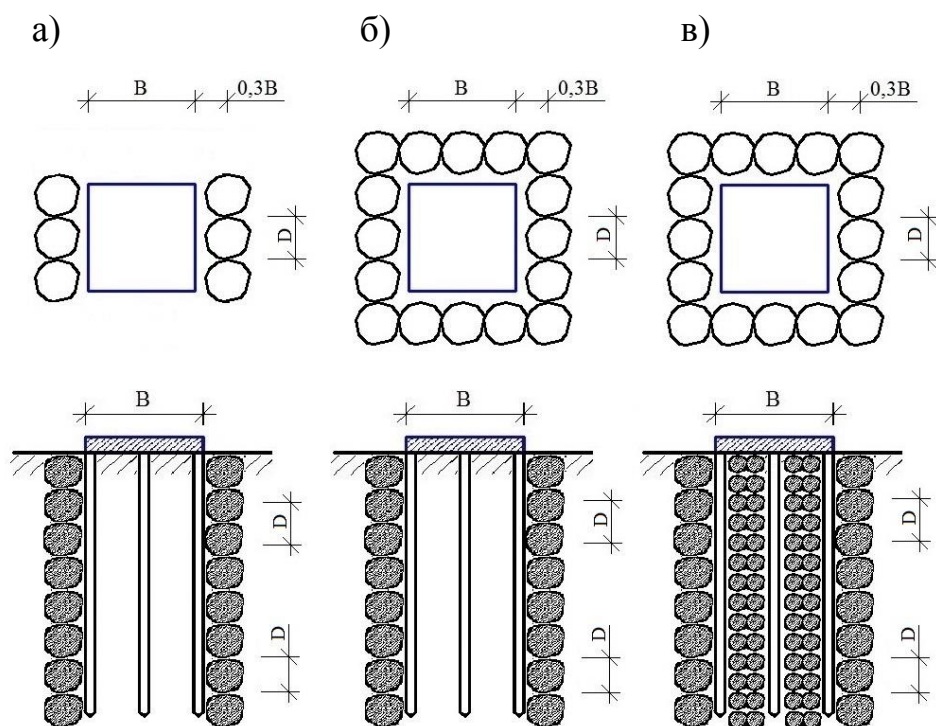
Схемы усиления модели свайного фундамента контурным армированием включениями диаметром D от подошвы до нижних концов стержней: а – сплошное вдоль двух противоположных сторон штампа; б – сплошное вдоль всего периметра штампа; в – сплошное вдоль всего периметра штампа с внедрением включений диаметром d в пространство между стержнями [167].
